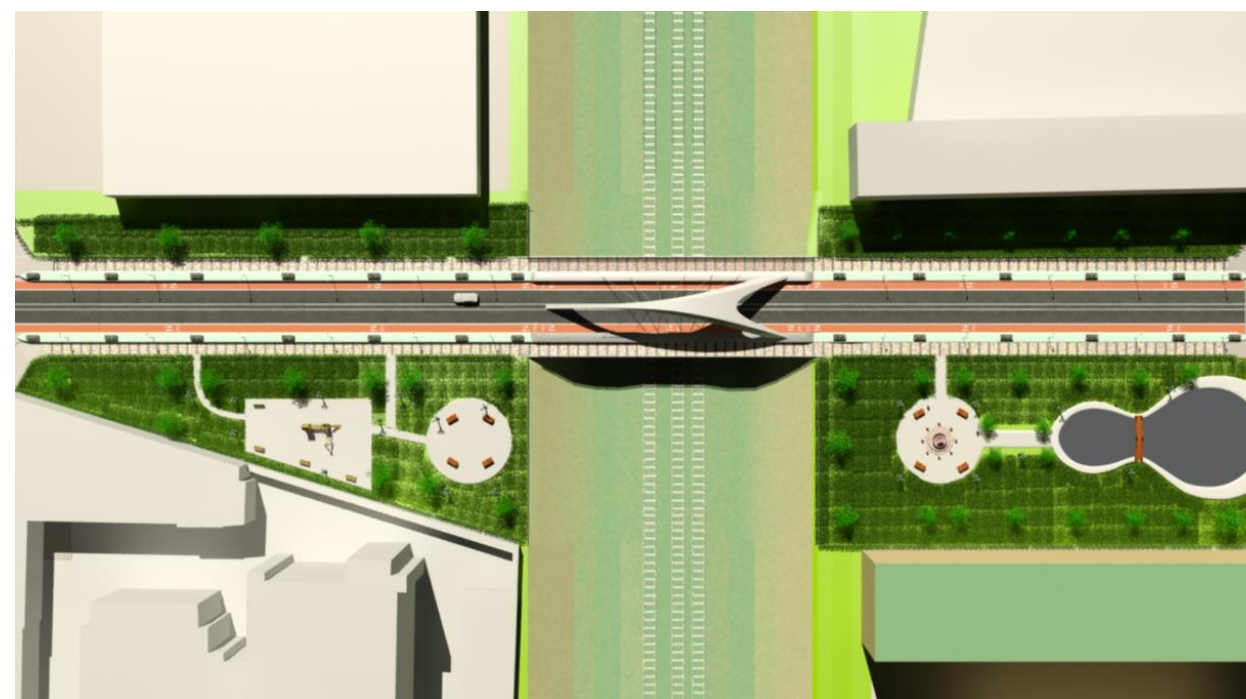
INFOGRAFÍA. VISTA EN PLANTA
